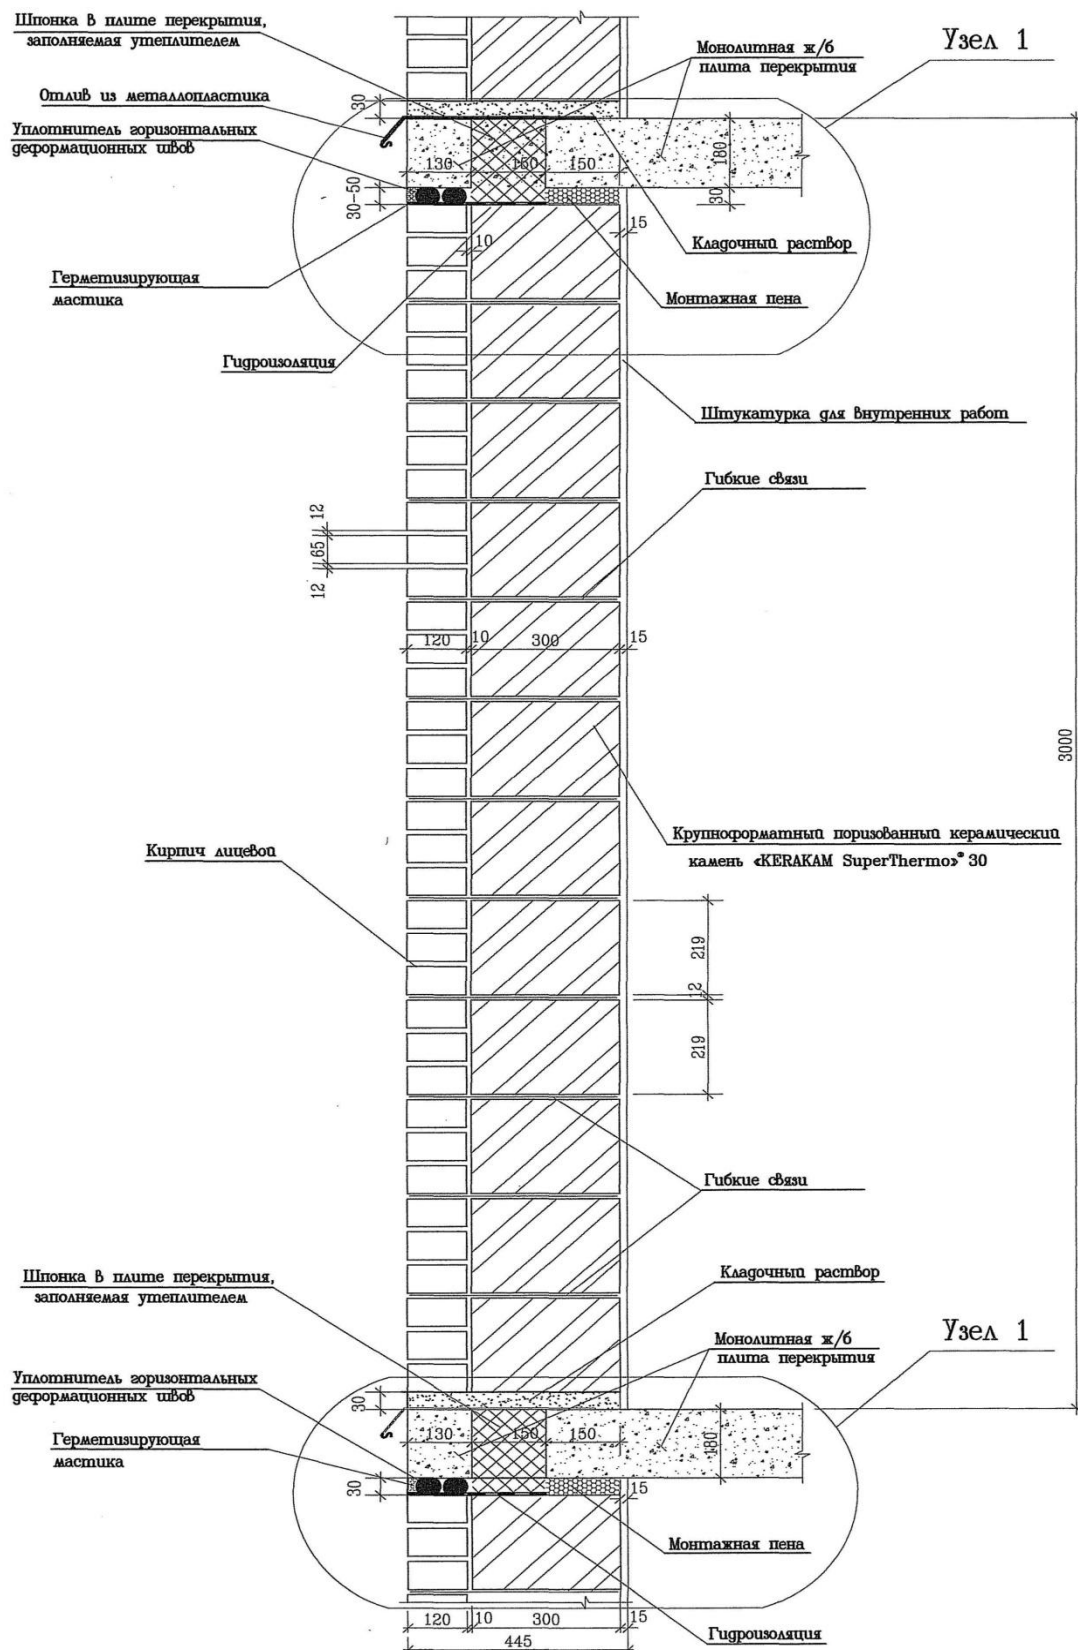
Разрез стены с облицовкой кирпичом без проемов.
